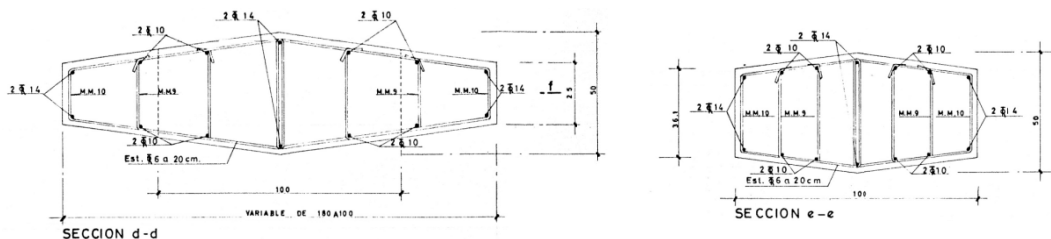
Armado correspondiente a dos secciones transversales horizontales de los pilares.
